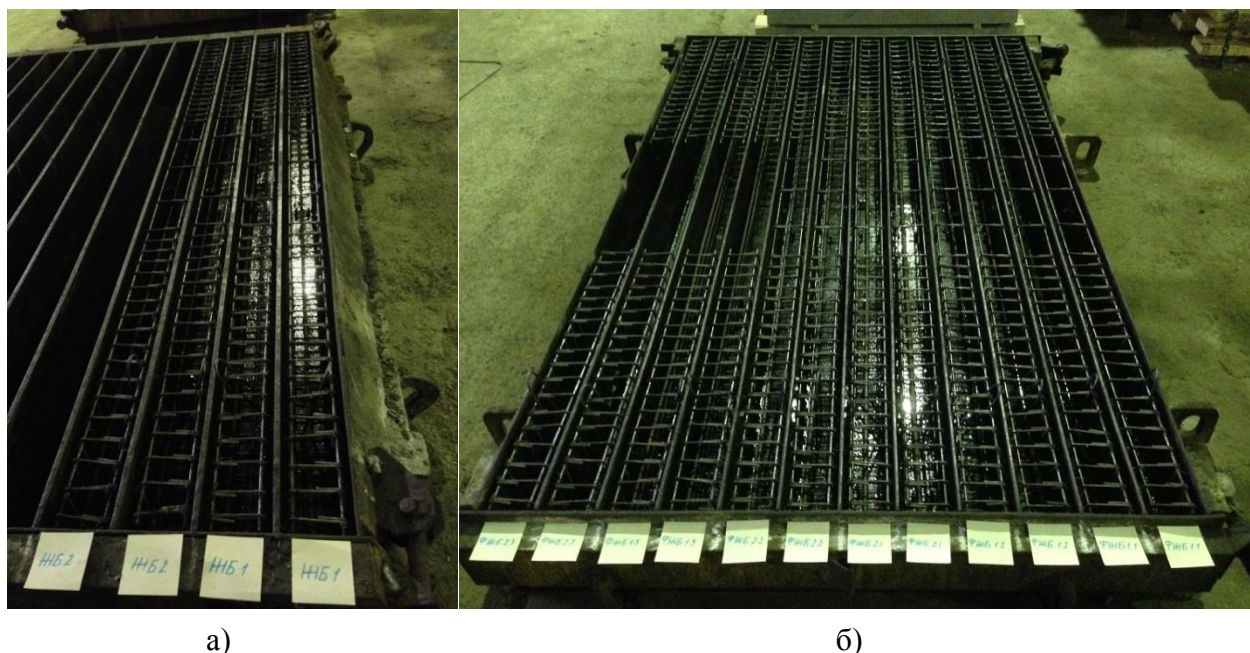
Общий вид форм с установленными арматурными каркасами для бетонирования железобетонных (а) и фиброжелезобетонных (б) балок
